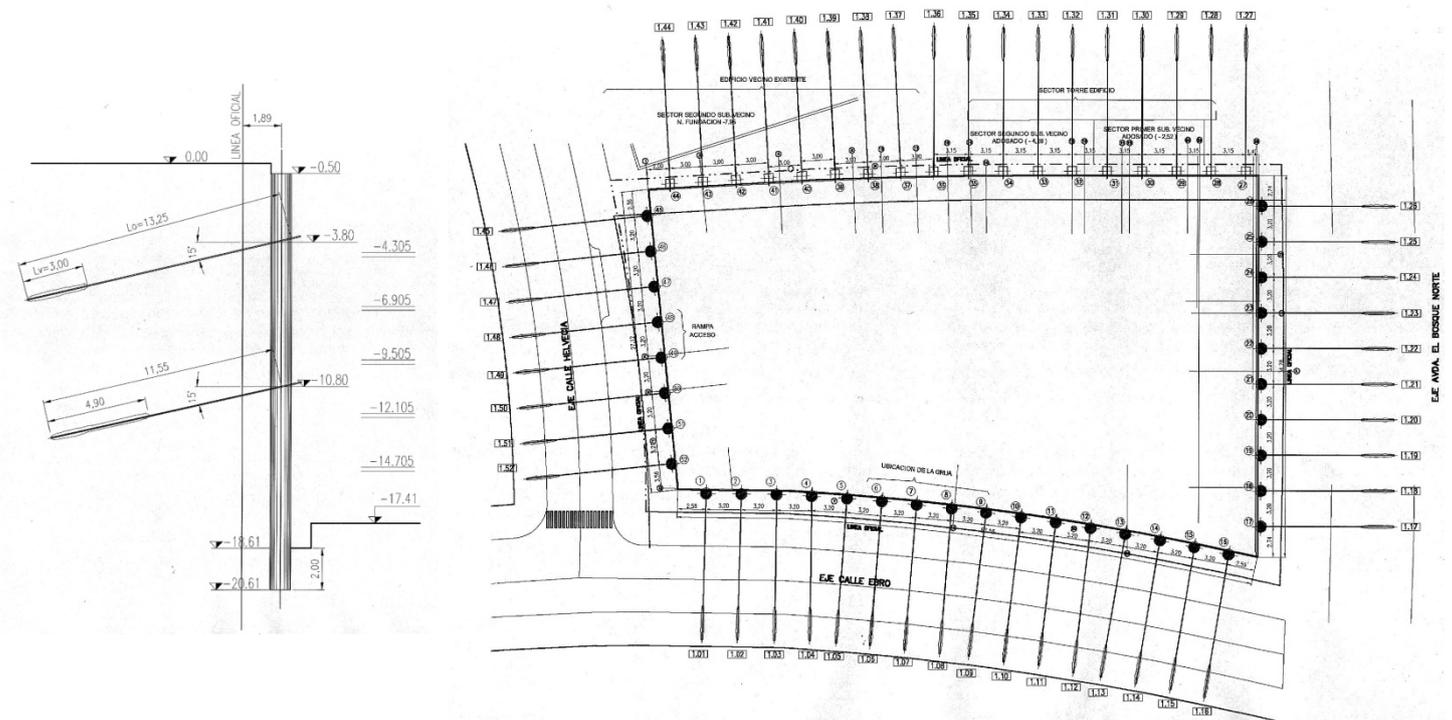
y 3 - Planta general de la entibación y sección transversal de la calle El Bosque
